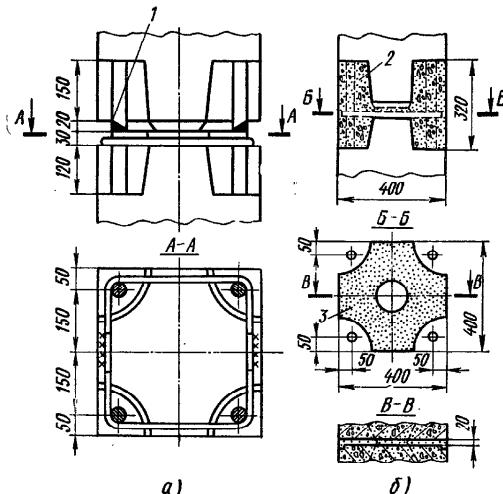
Стык железобетонных колонн с гибкой арматурой:
